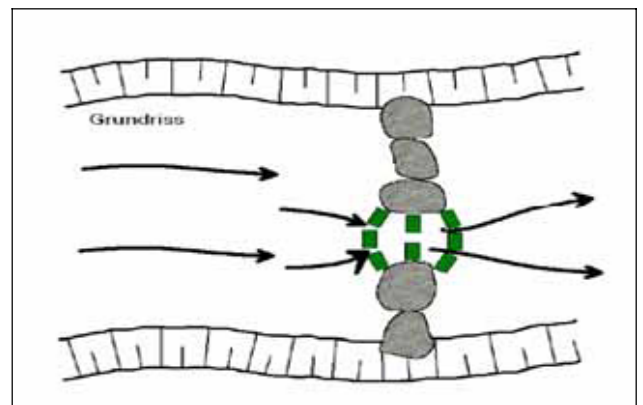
Grundriss Raugerinne-Beckenpass mit überfahrbaren Elementen.
